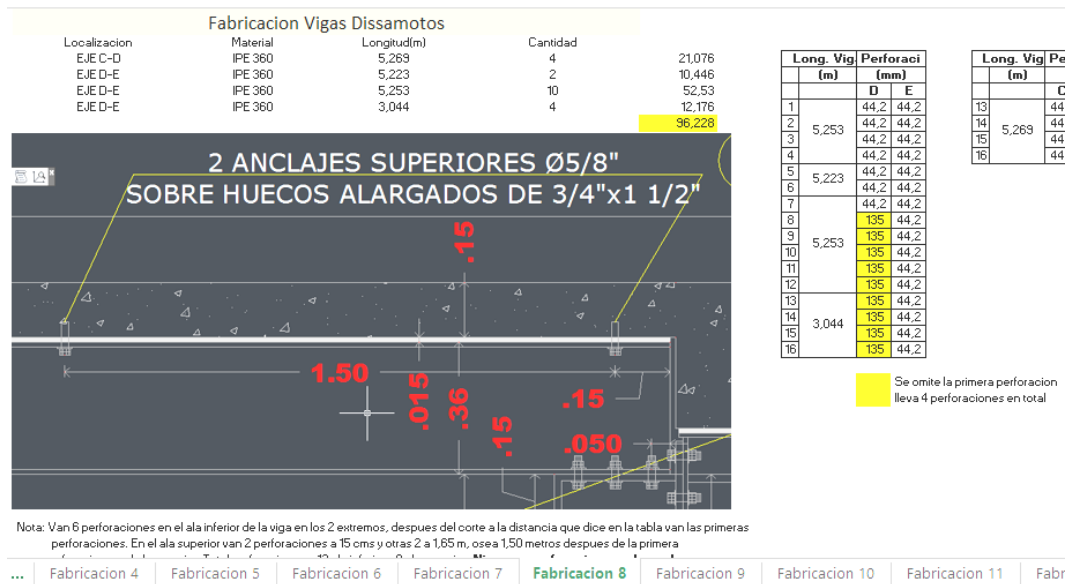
Orden de fabricación Columnas y vigas metálicas Dissanmotos.
